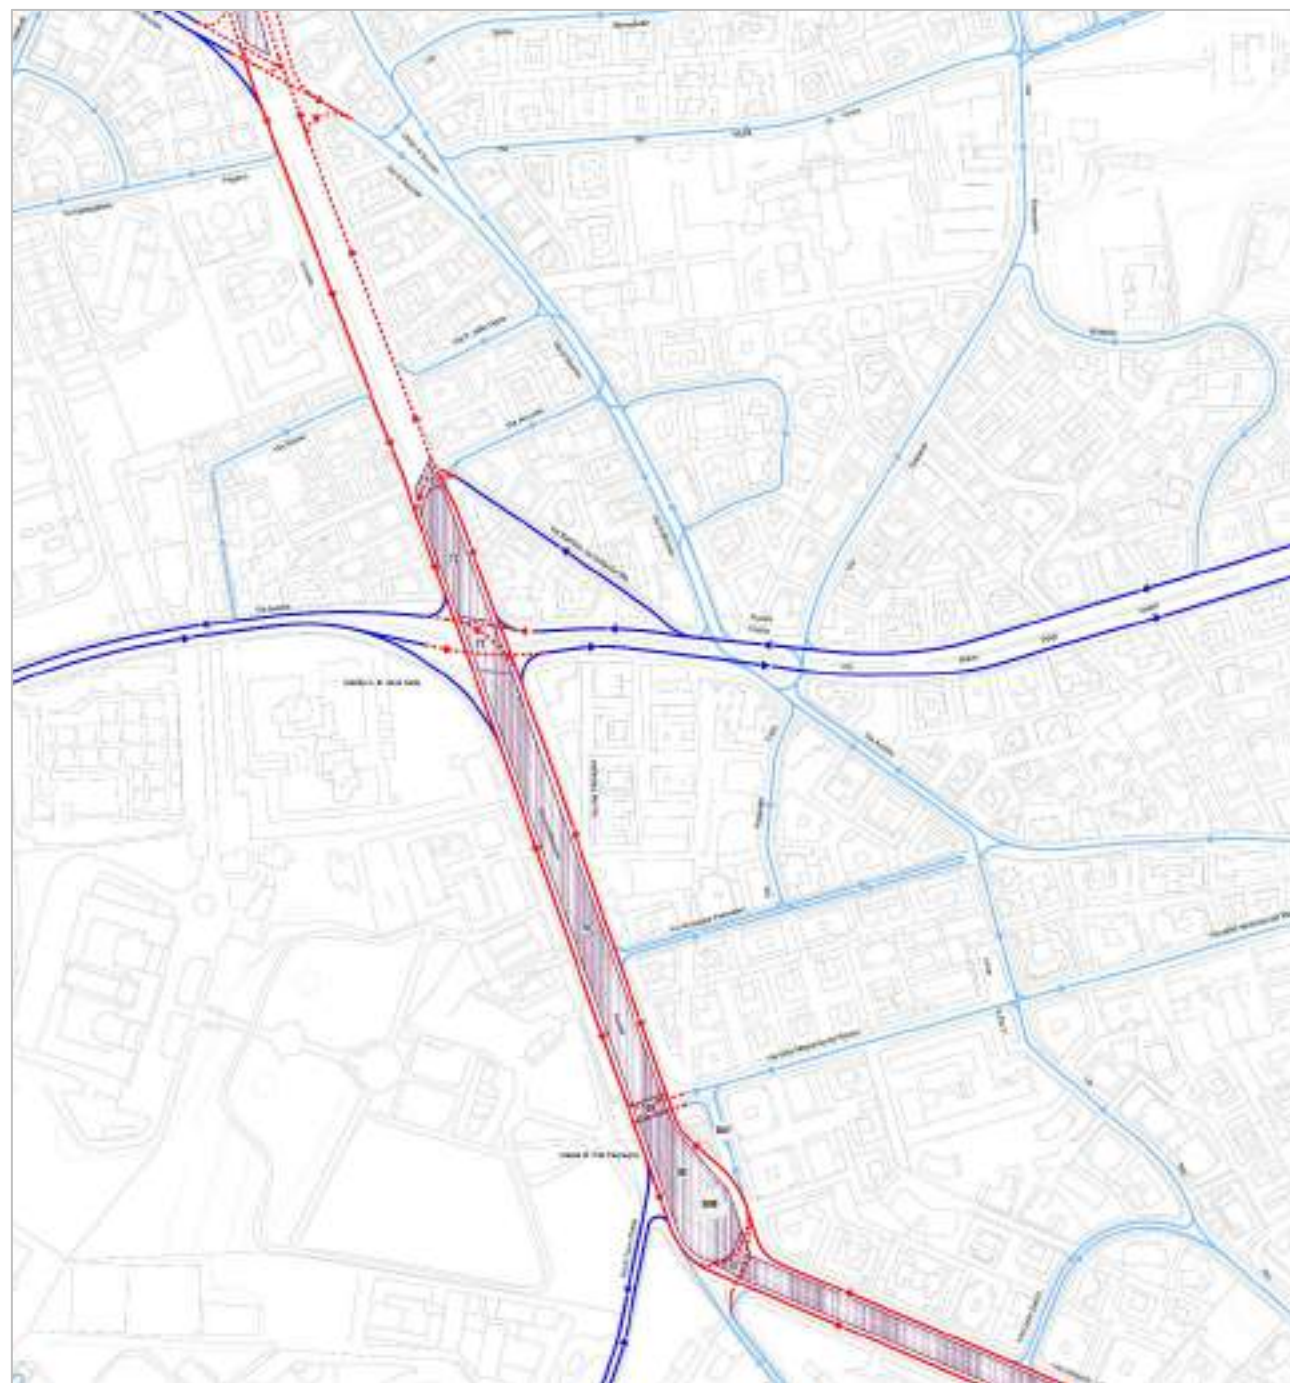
Schema circolazione di cantiere sesta macro fase: zona Circonvallazione Aurelia e Cornelia
